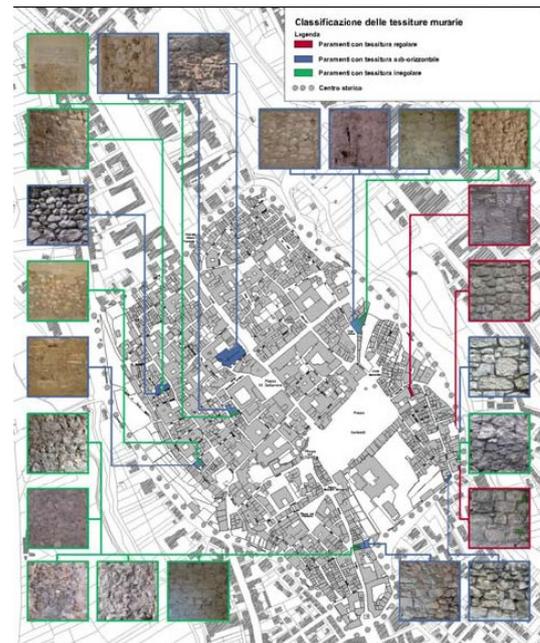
Individuazione degli edifici rilevati con muratura faccia vista nel centro storico di Sulmona.
